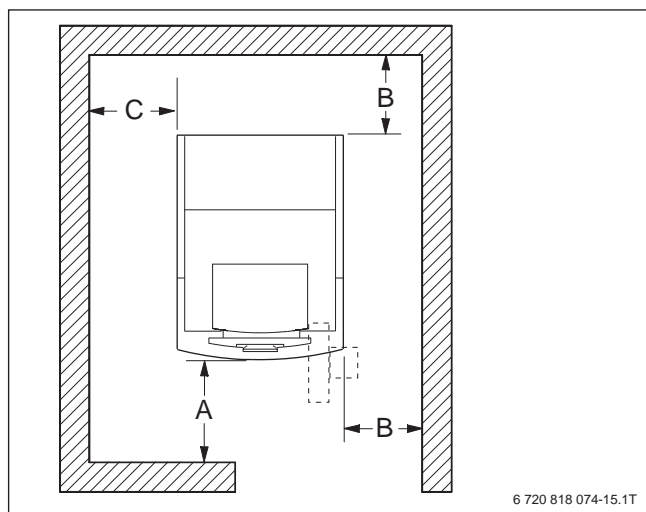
Wandabstände (Draufsicht) im Aufstellraum (Heizkessel links oder rechts positioniert)
